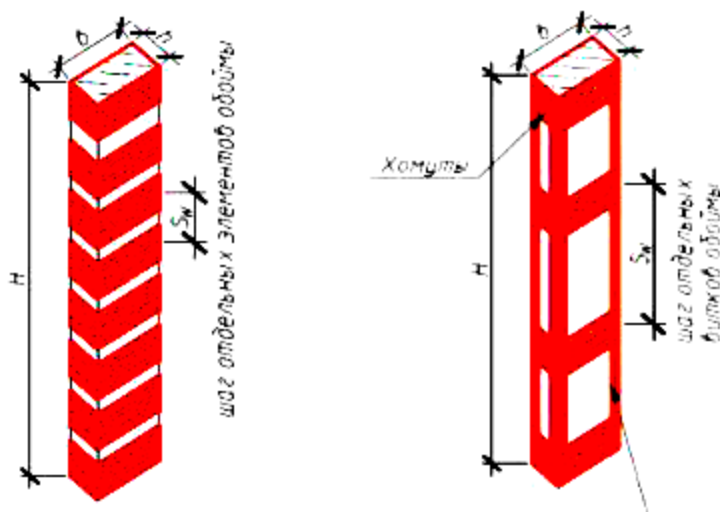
Схема усиления железобетонной колонны каркаса подземной части здания с применением внешнего усиления композитными лентами
